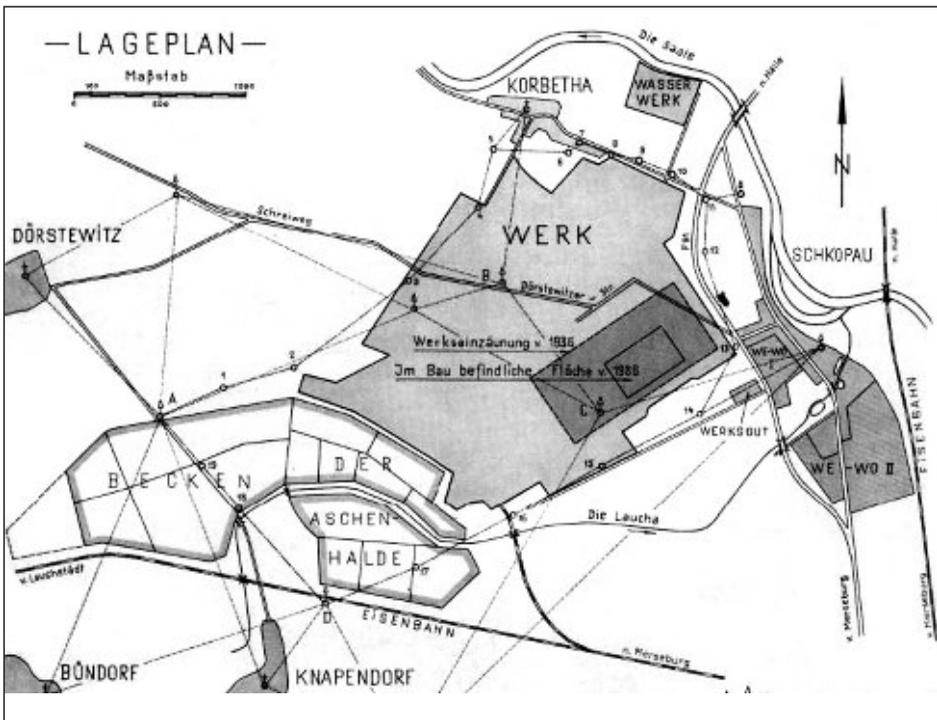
Der Lageplan des Buna-Werkes Schkopau aus dem Jahre 1936 [18]
